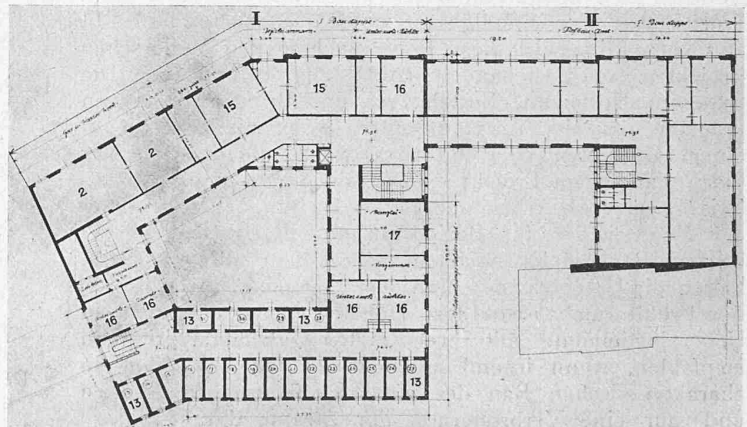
und 13. Grundrisse des Bezirksgebäudes. — Masstab 1:800.
